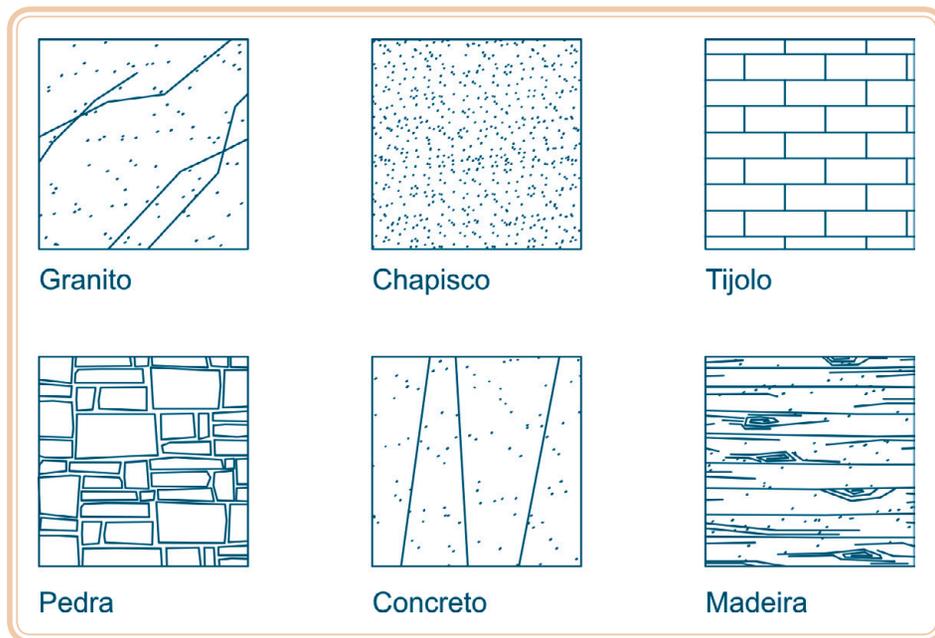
Elementos usados nas fachadas – materiais de acabamento
